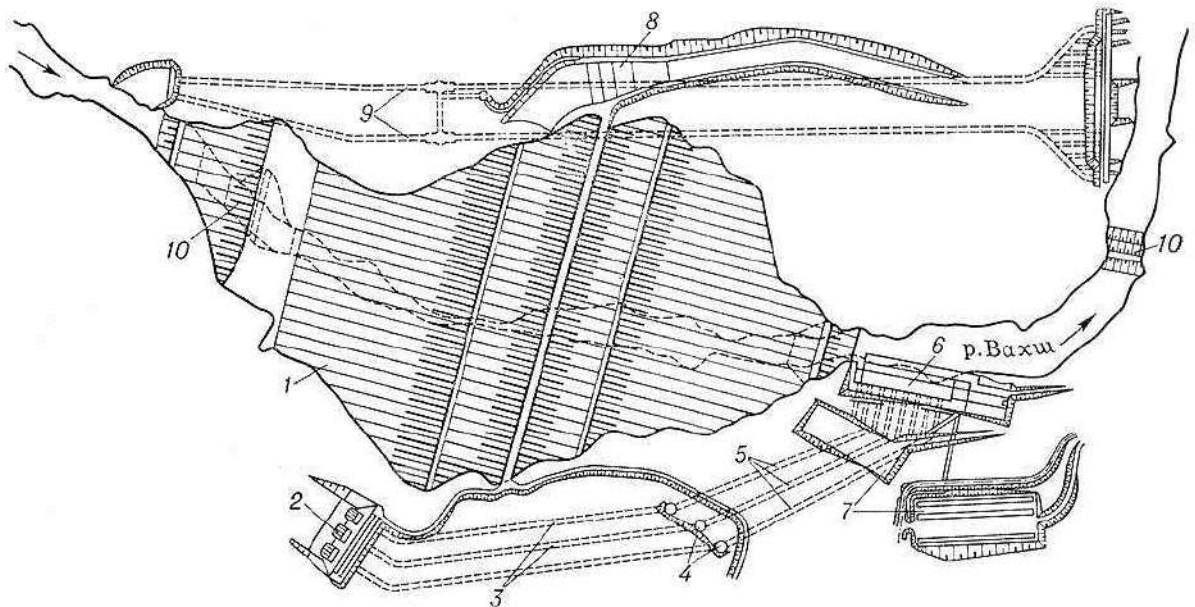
Схема гидроузла Нурекской ГЭС на р. Вахш: 1 - плотина; 2 - водоприемник ГЭС; 3 - напорные водоподводящие туннели; 4 - уравнильные резервуары; 5 - турбинные водопроводы; 6 - здание ГЭС; 7 - открытое распределительное устройство; 8 - открытый водосброс с отводящим каналом; 9 - строительные туннели; 10 - верховая и низовая перемычки
